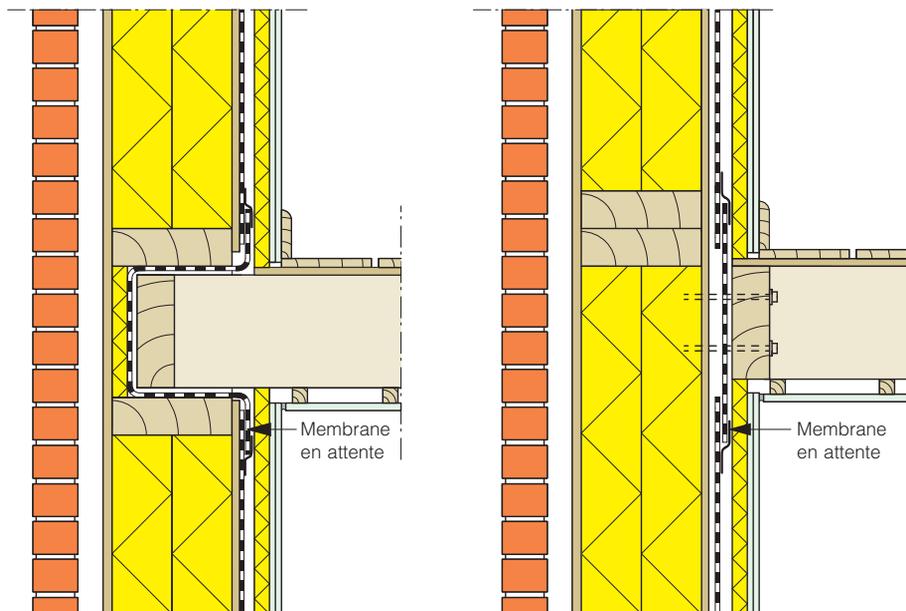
Raccord entre une paroi à ossature en bois et un plancher d'étage en bois
